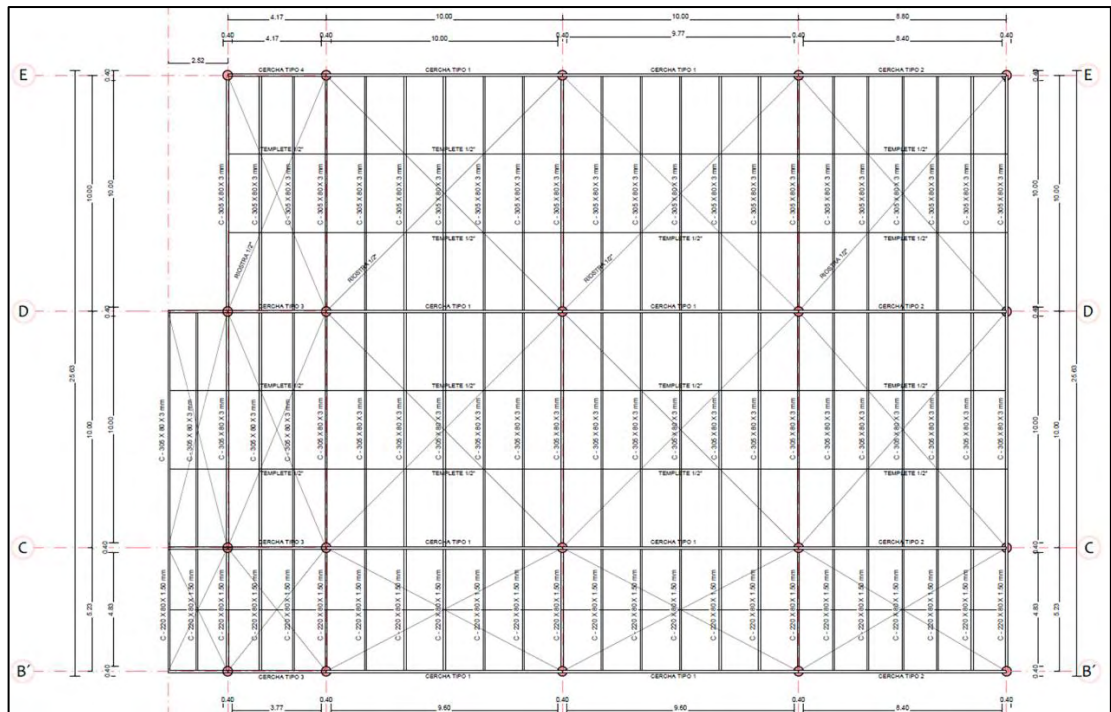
Planta de estructura de cubierta modificada Zona B
